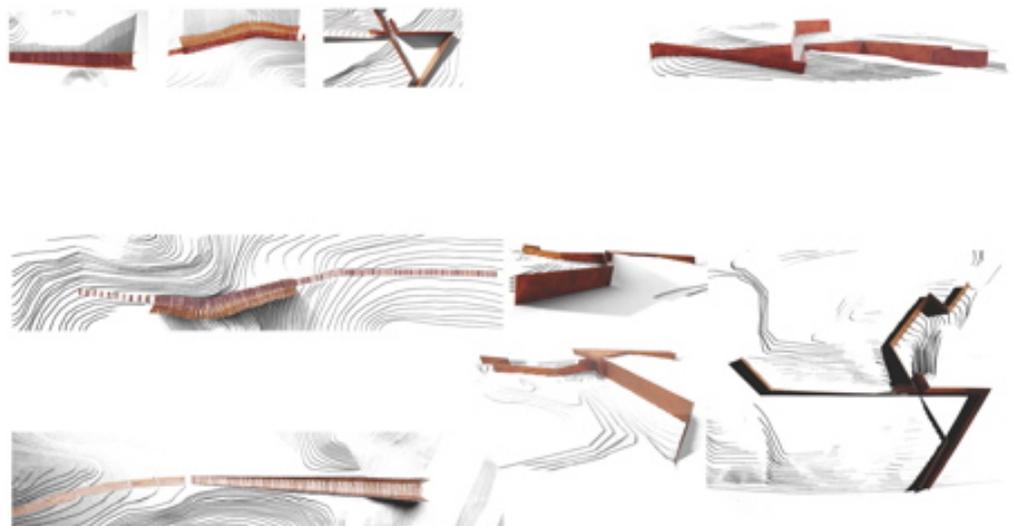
,77,78: Pedra Tosca Park: Grundriss (o.), Foto (li.), Pläne (re.)
